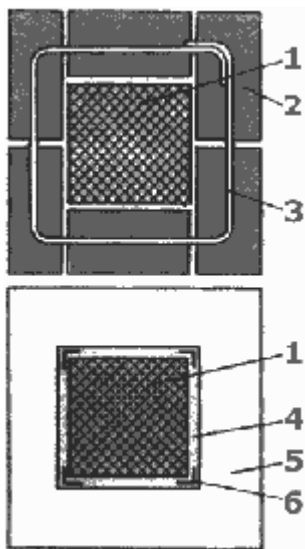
Усиление опоры кирпичной кладкой: 1 - старая опора; 2 - новая кирпичная кладка; 3 - арматура; 4 - полосовая сталь; 5 - бетон; 6 - стальные уголки.
